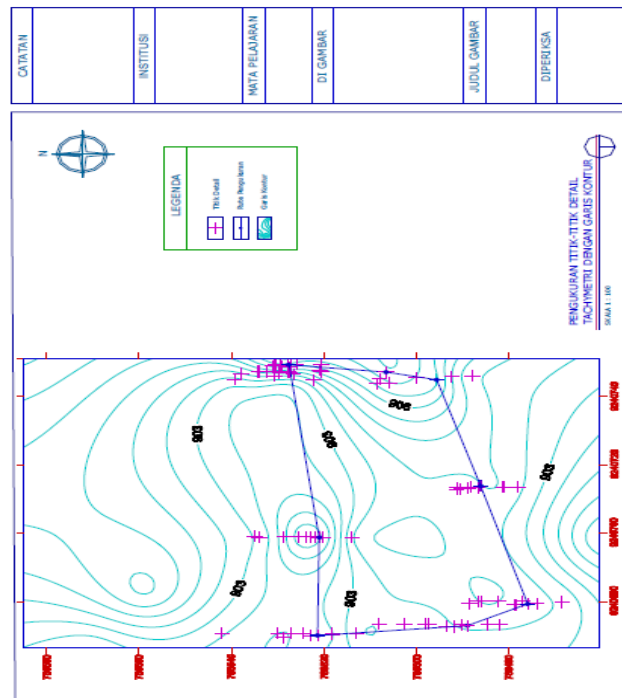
Siteplan pengukuran titik-titik detail Tachymetri
